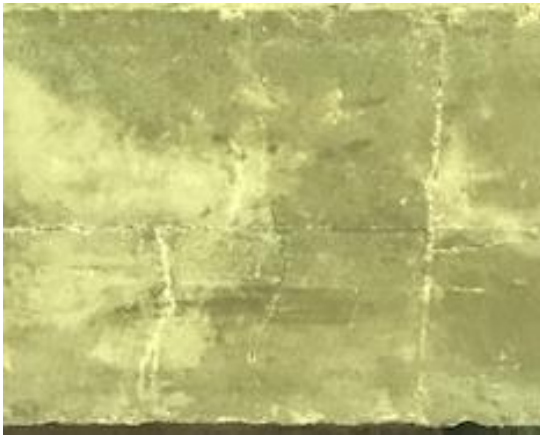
Fisura en la parte inferior de una viga intermedia en la zona central
